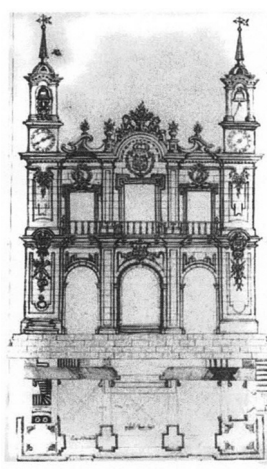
Álvarez Benavides. Fachada Ayuntamiento. Proyecto de nueva fachada.
